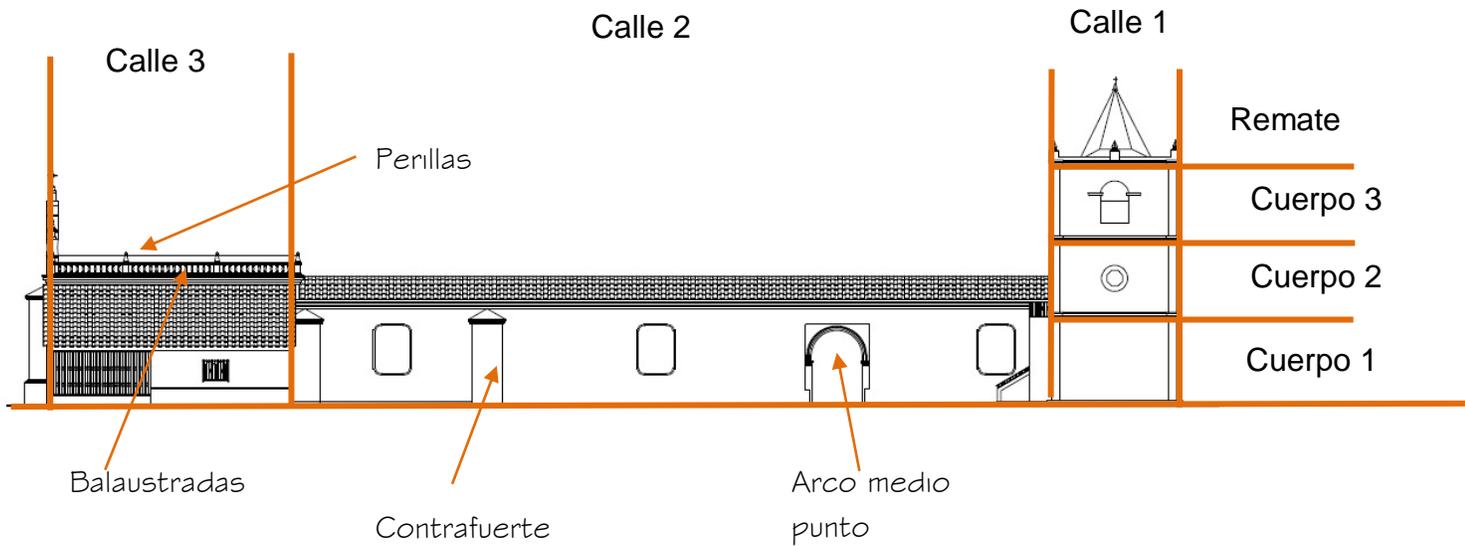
Elevación norte. Autor: Grupo de trabajo.
